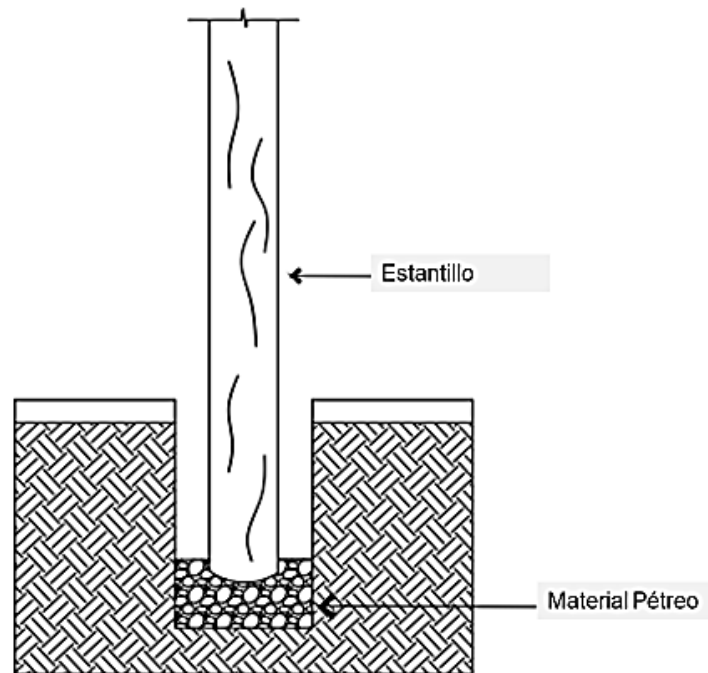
Detalle de cimentación. Ilustración de caja en corte para el arranque del estantillo. Elaboración propia con AutoCAD
